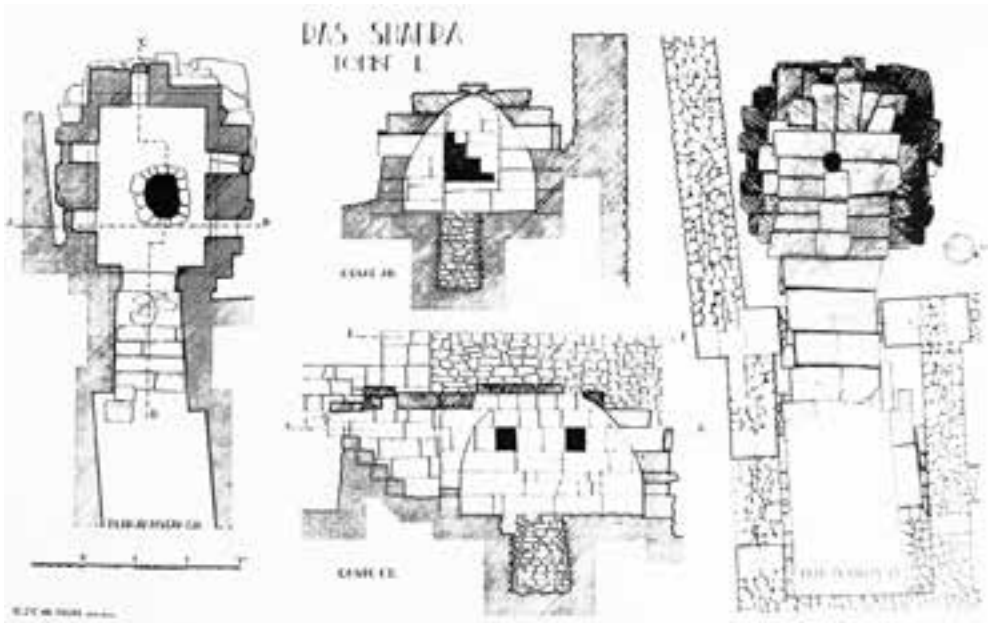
Planimetria di tomba a camera costruita con pozzo (da SALLES 1995, fig. 18.3)
